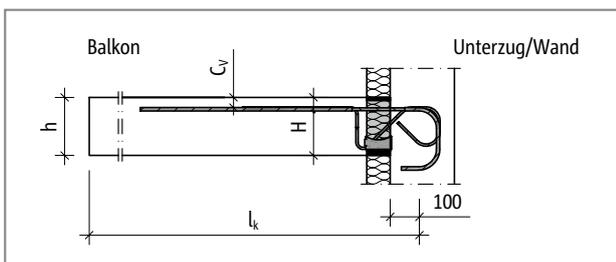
Schöck Isokorb® T Typ KL-O-M8 bis KL-O-M12: Statisches System
